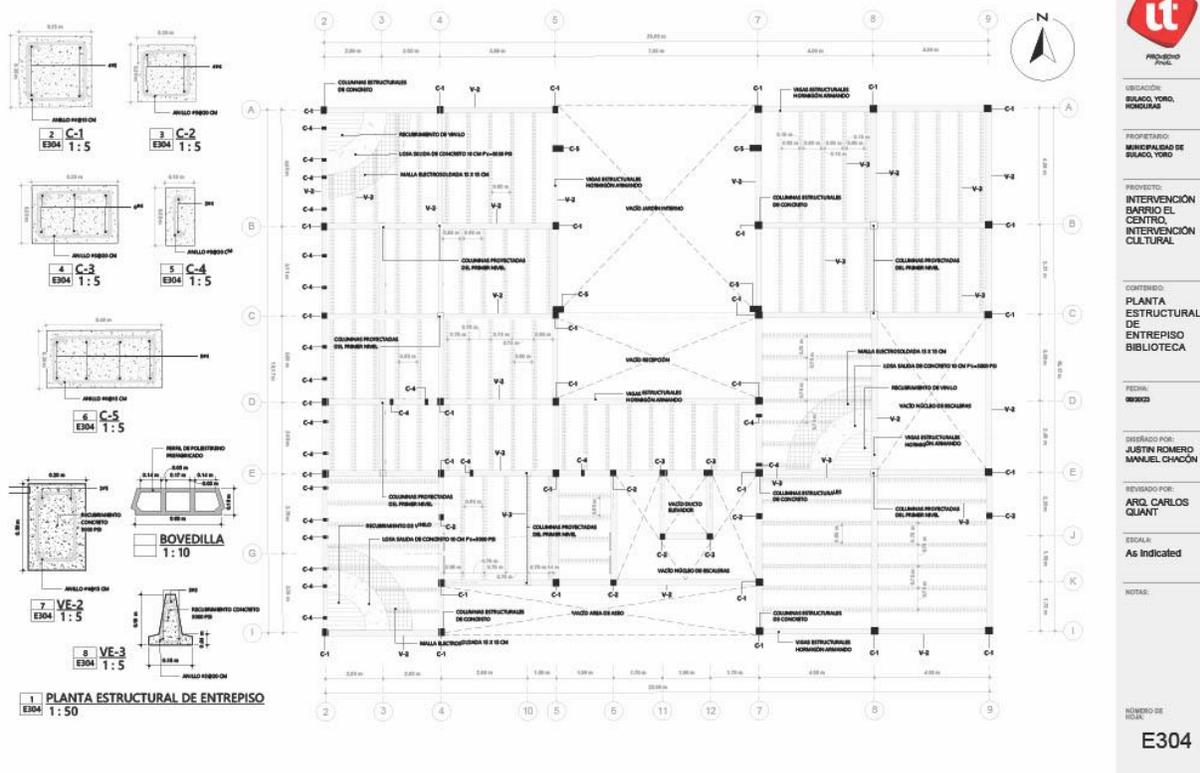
Planta de Estructura Entrepiso | Fuente: elaboración Propia
